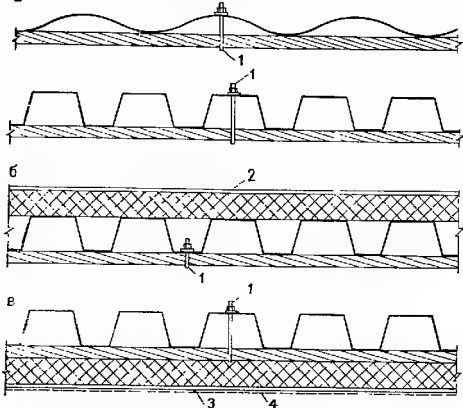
Конструкция кровли из профилированных листов в вантовых покрытиях
